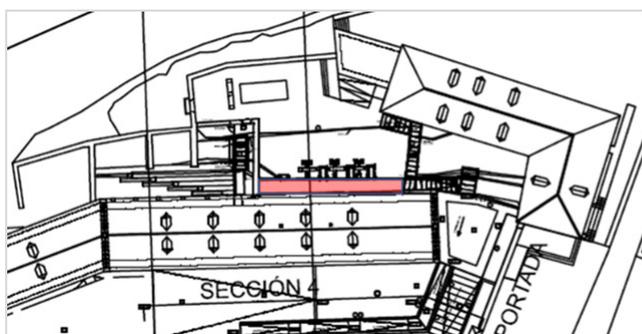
Planta de ubicación del canal a impermeabilizar y detalle del canal.
